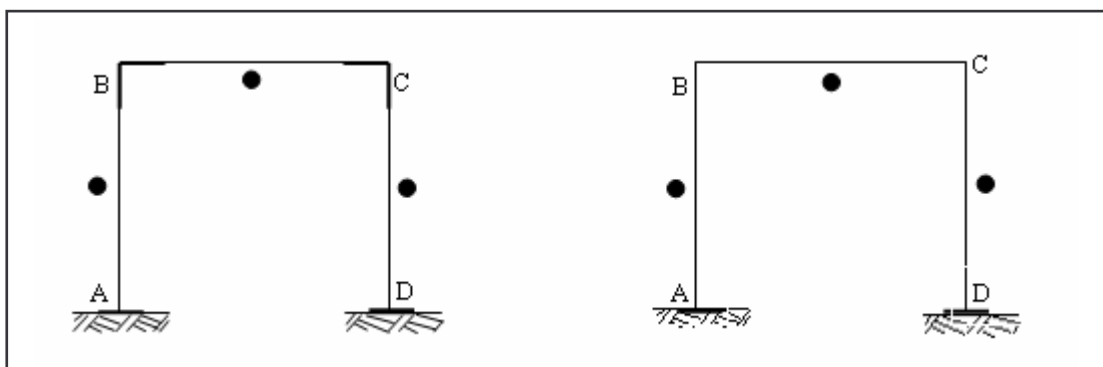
Pórtico plano compuesto por 4 juntas y 3 miembros ●
